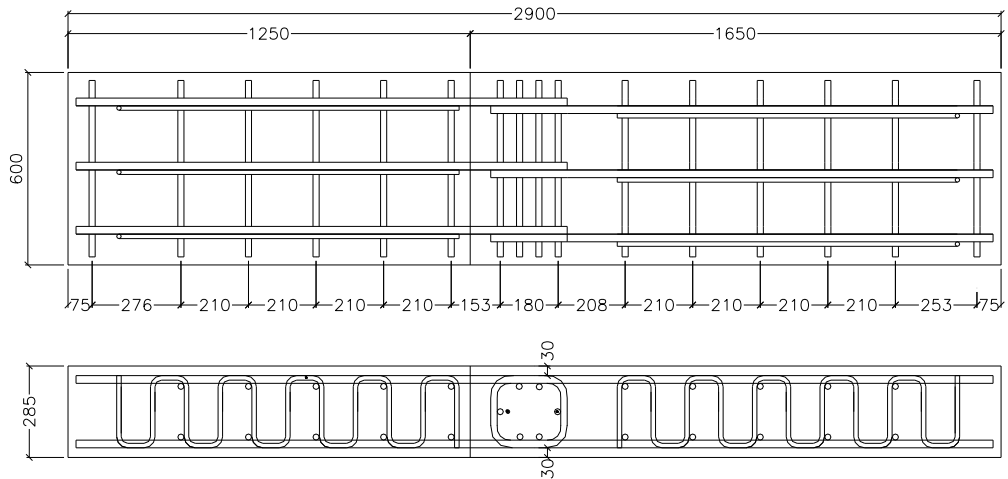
Planos en planta y perfil de las losas SCC-N-1/2, NSC-N-1/2, HSC-N-1/2.
